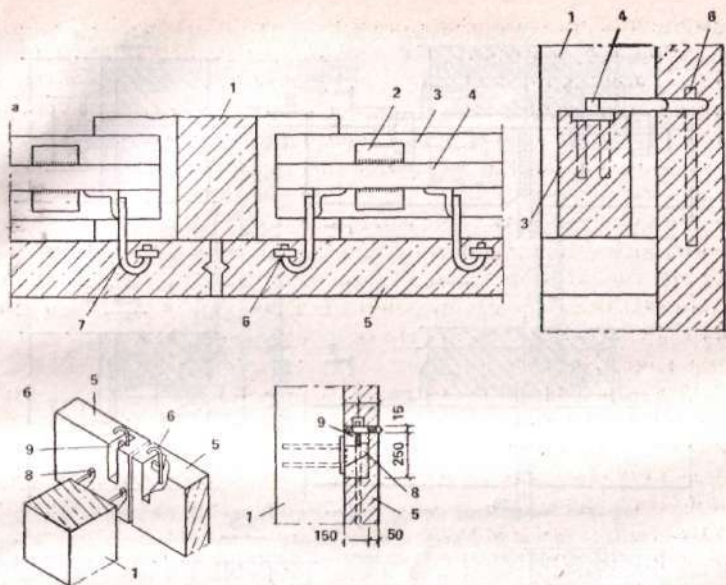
Схемы крепления навесных панелей к каркасу противопожарных стен *а* — при расположении крепежных элементов на ригеле; *б* — при навеске панелей на колонны (разработано Госхимпроект); 1 — колонна; 2 — закладные элементы; 3 — ригель (балка); 4 — стальной стержень; 5 — навесные панели; 6 — петли; 7 — анкеры; 8 — опорные консоли; 9 — несущие элементы
